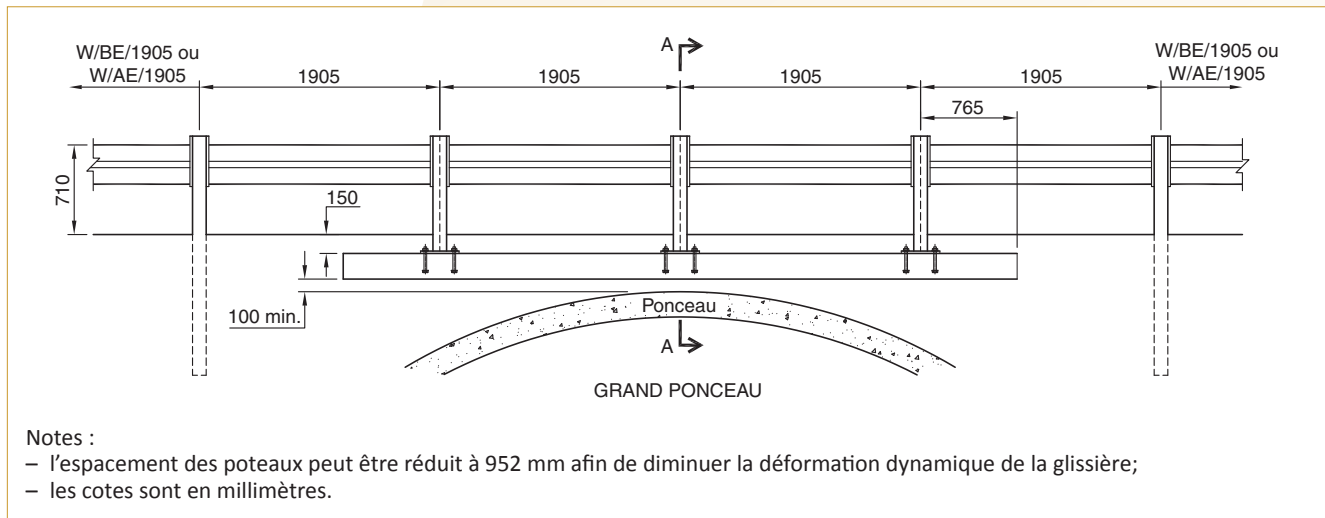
Exemple d'installation d'une dalle à trois poteaux
